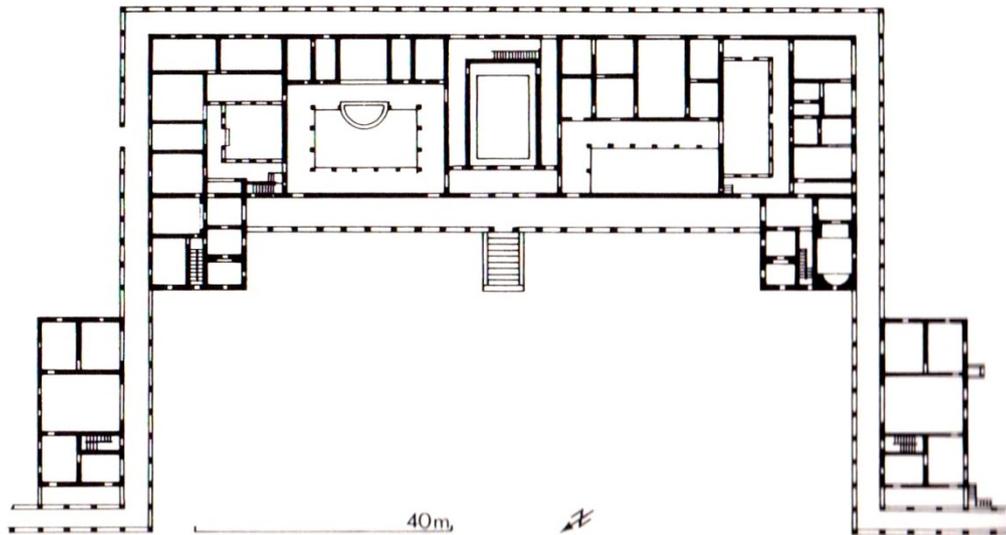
M. Boß: Grundriss der Villa in Nenning, o.J., o.A.
